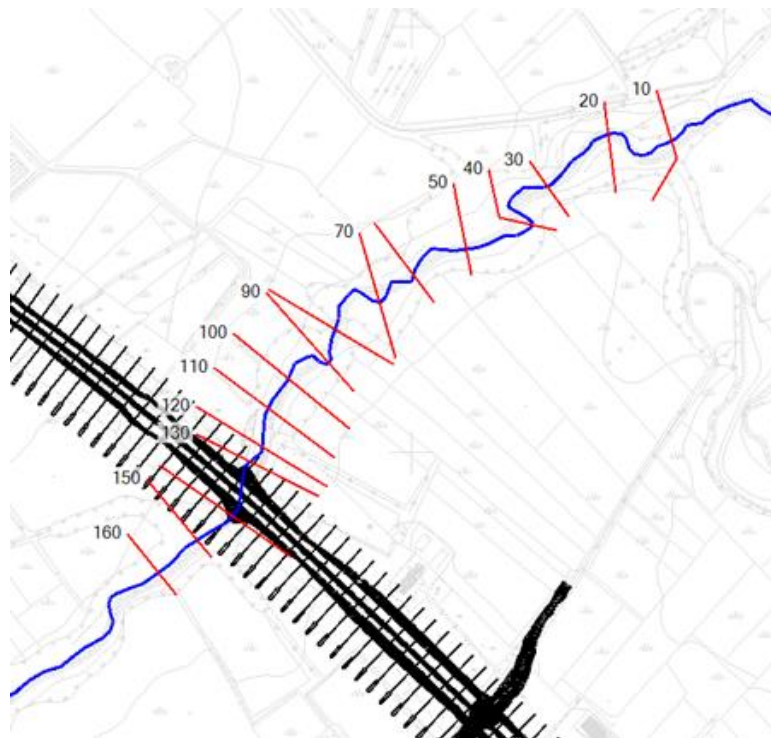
Inquadramento planimetrico della nuova opera VI21: sezioni modellate (planimetria modello idraulico)
